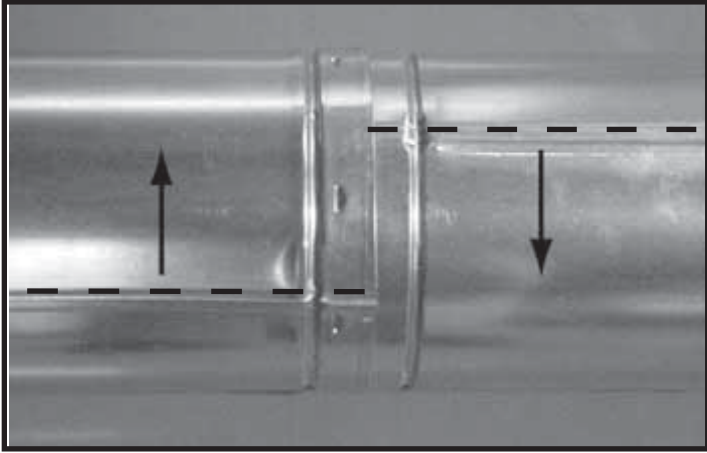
Pivoter les cordons de soudure pour démonter
